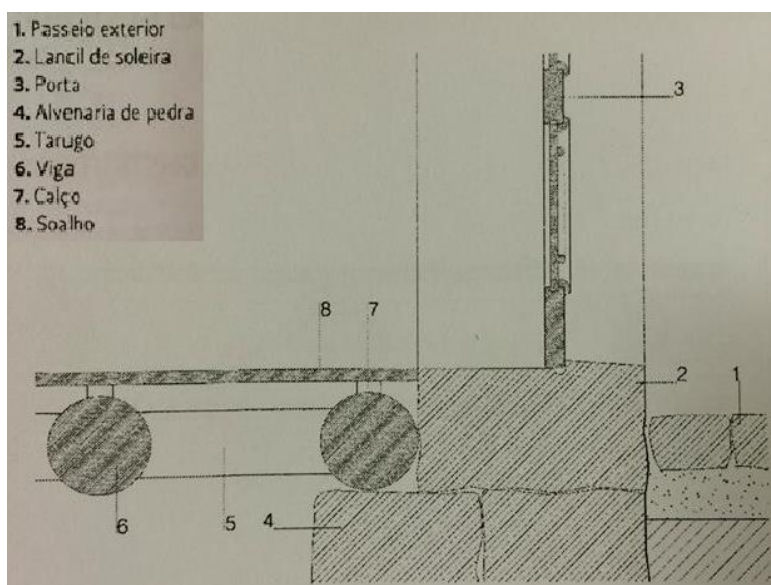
Pormenor construtivo do pavimento de madeira / parede exterior [6]
